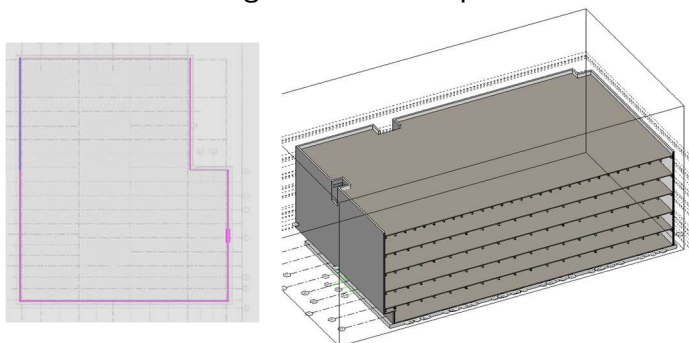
perimetro pavimentazione sinistra, Figura 45 destra
